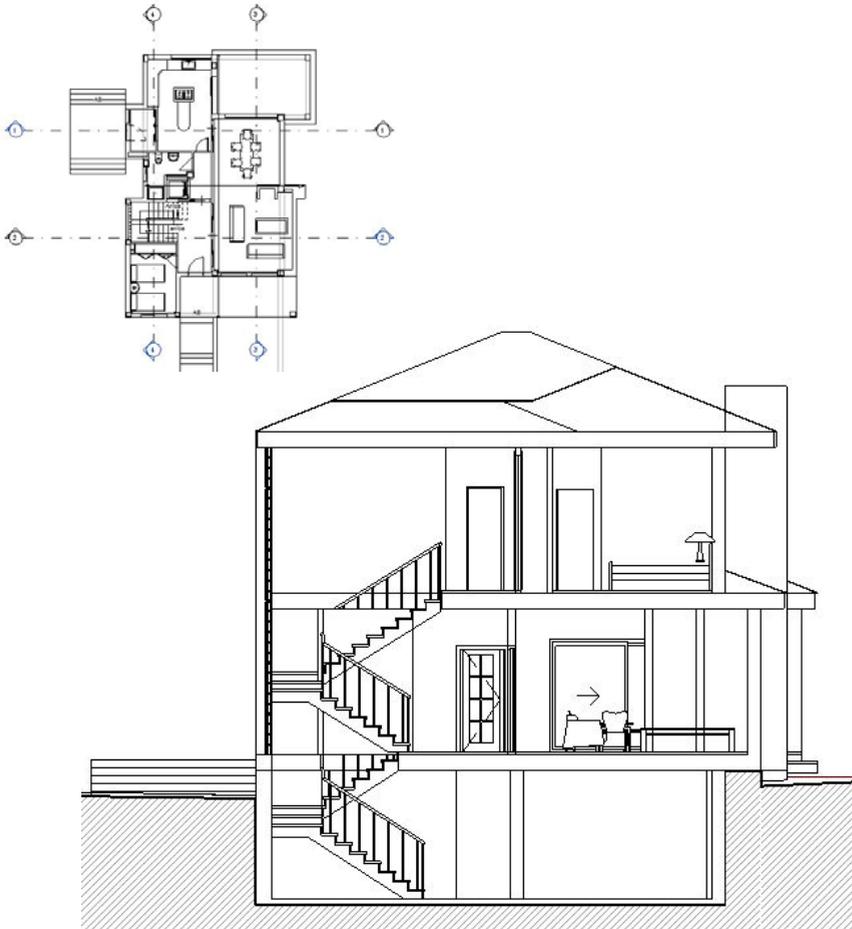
Sección 2 - 2' . Fuente propia Revit
